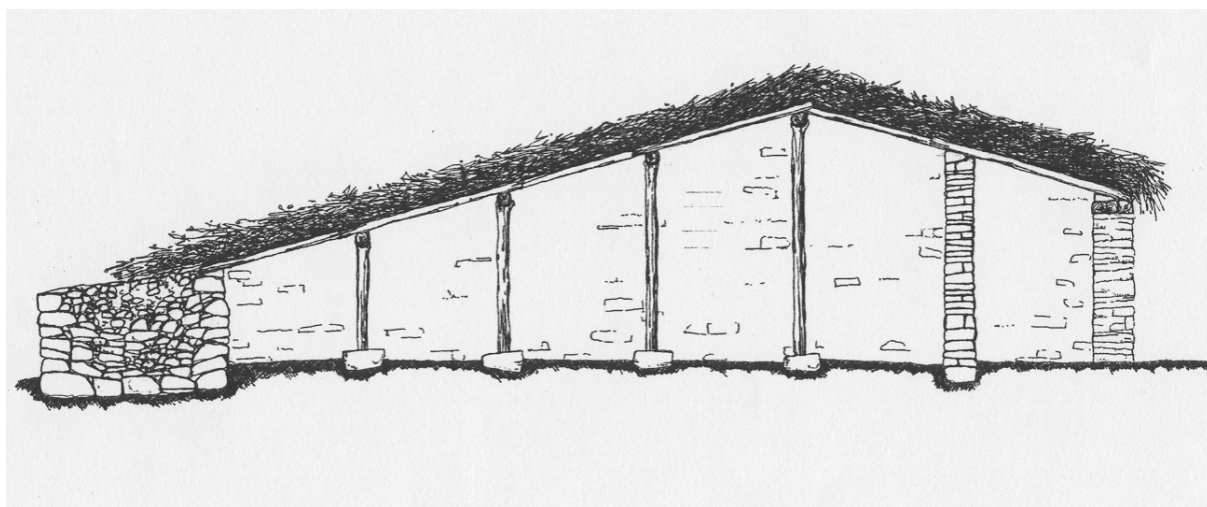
El Ceremeño, Herrería (Guadalajara). Propuesta de sección longitudinal correspondiente a la vivienda E
